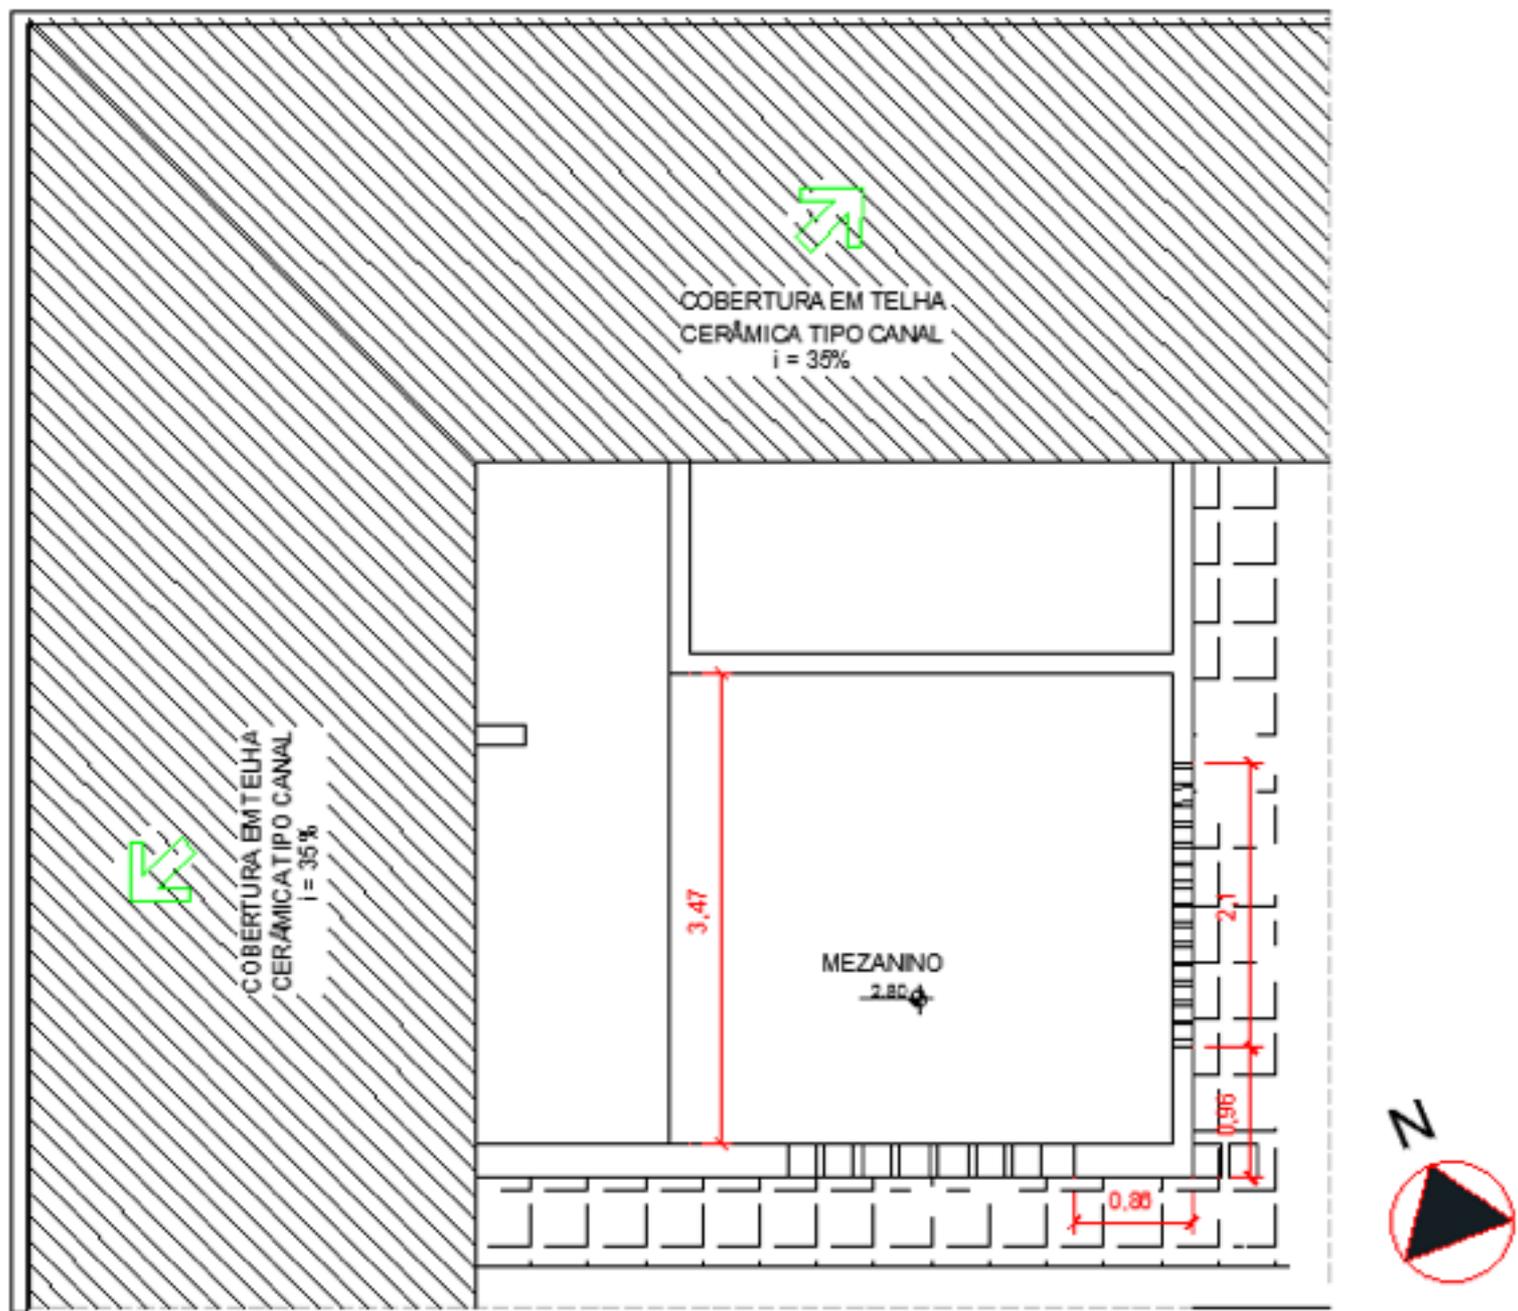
Planta baixa do pavimento superior da Eco-Residência
